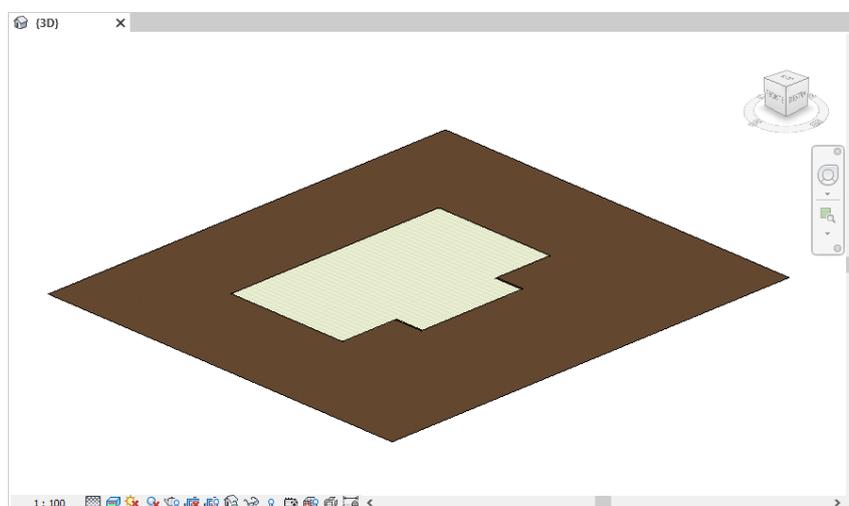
Vista tridimensionale platea provvisoria (3D)
